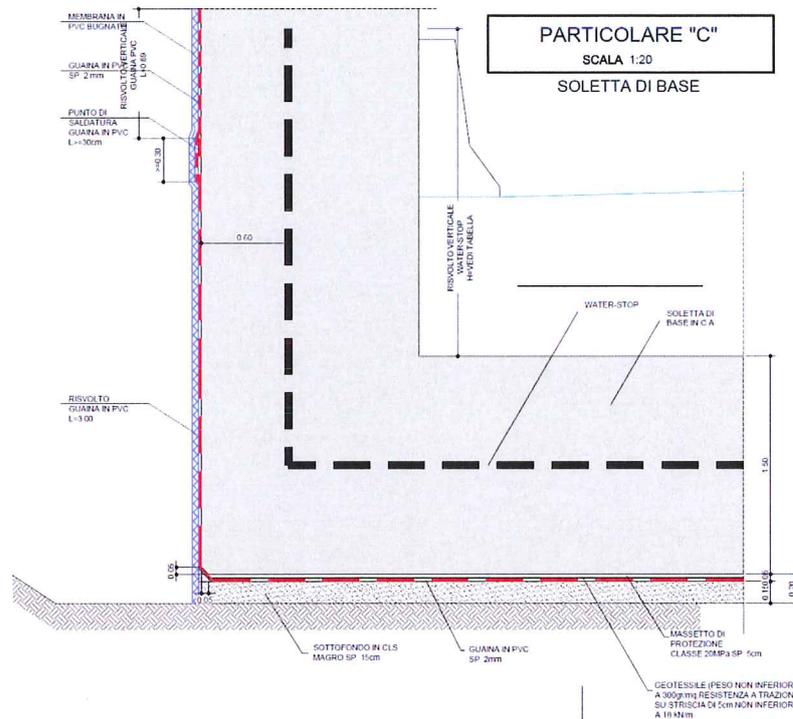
Particolare impermeabilizzazione solettone di fondo (sezione scatolare)
